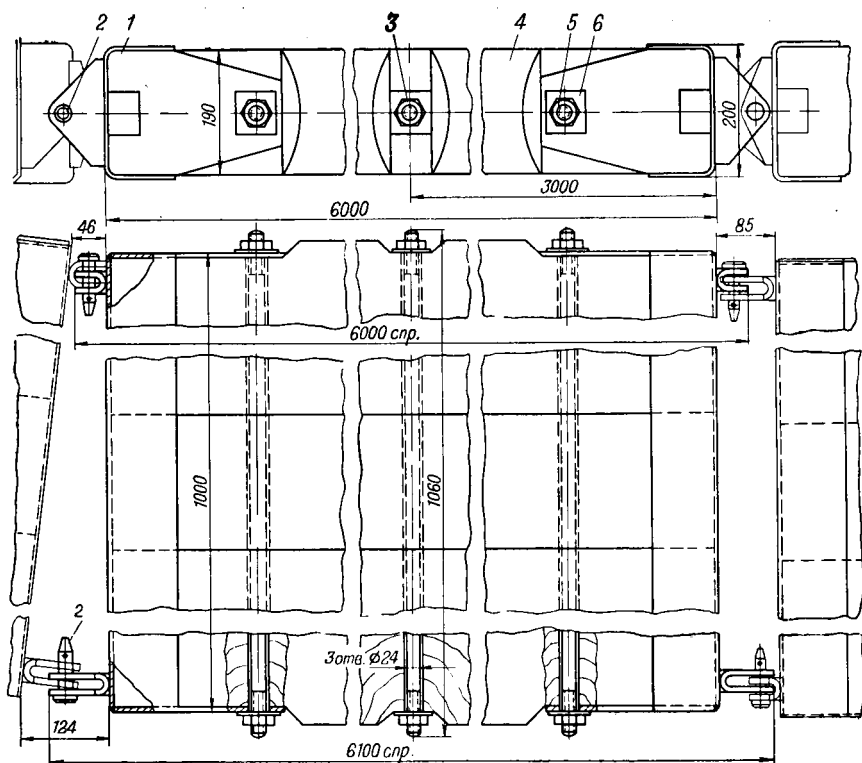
Деревянный щит ЛВ-11 с металлическим креплением конструкции ЦНИИМЭ:
